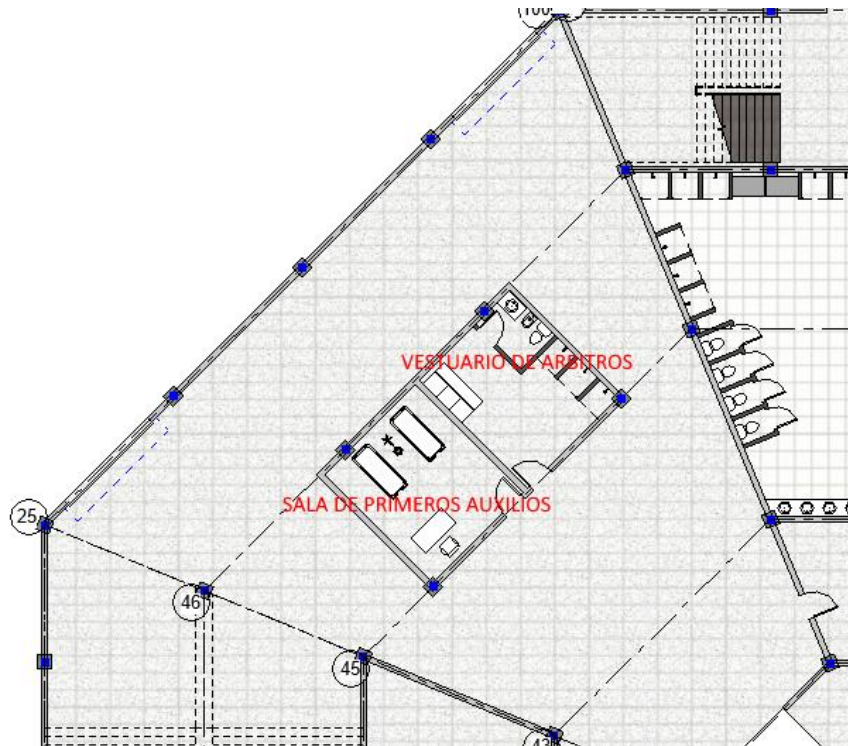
Vista en planta del sector noroeste de la planta baja. Fuente: elaboración propia.
